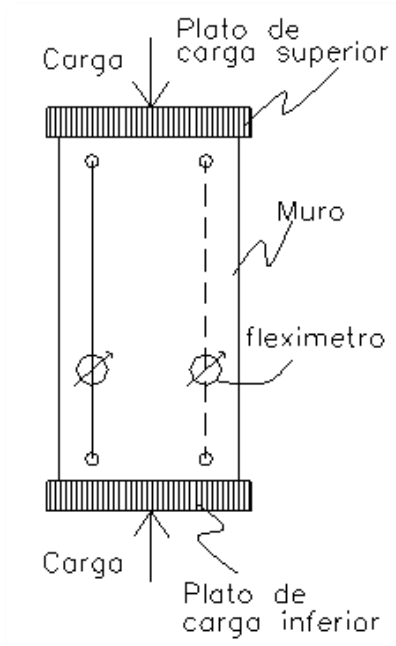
Esquema Dispositivo para Ensayo IRAM 11.588.
